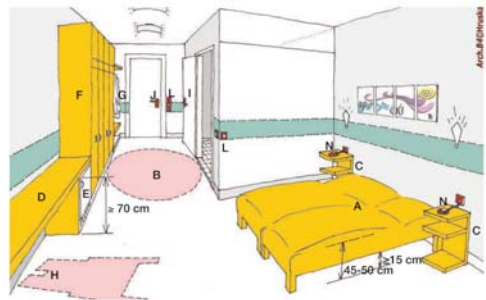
Gästezimmer/Hotelzimmer mit unterfahrbarem Doppelbett
